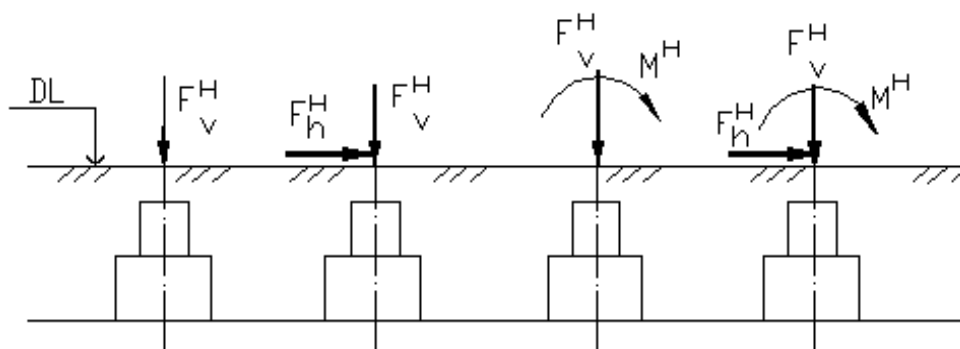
Расчетные схемы действия нагрузок на фундаменты.
